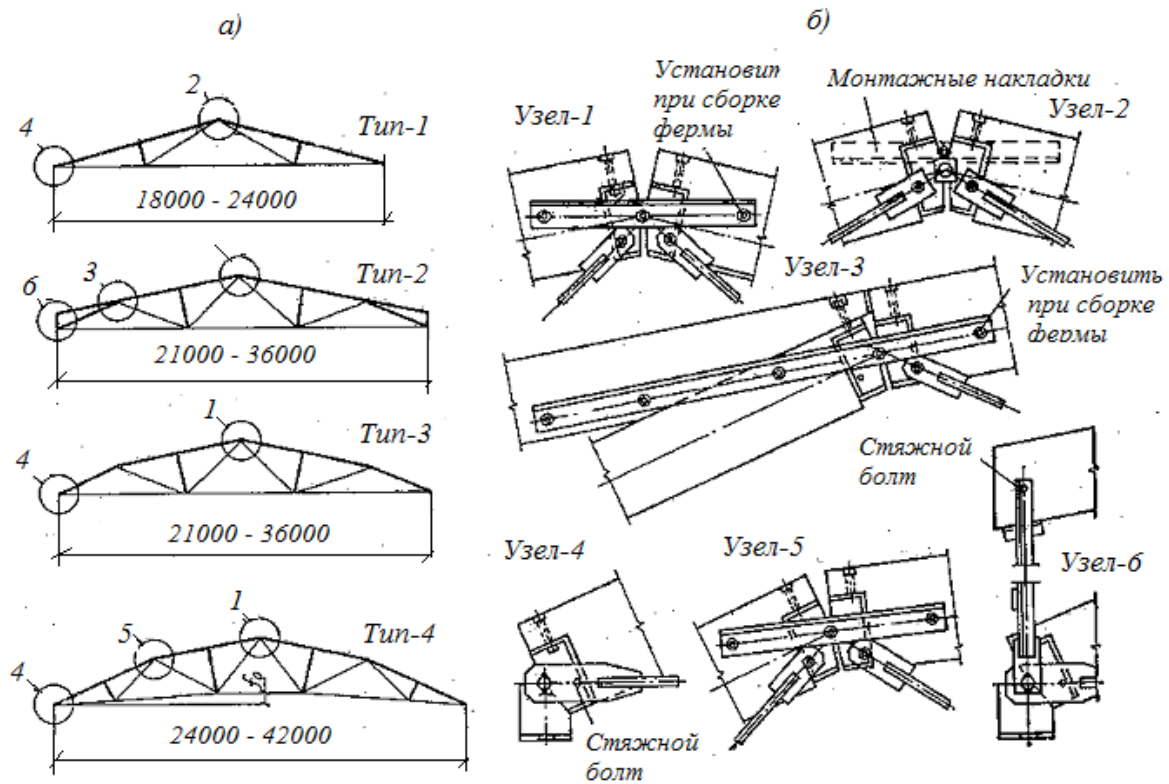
Схемы металлодеревянных ферм с клееным верхним поясом
